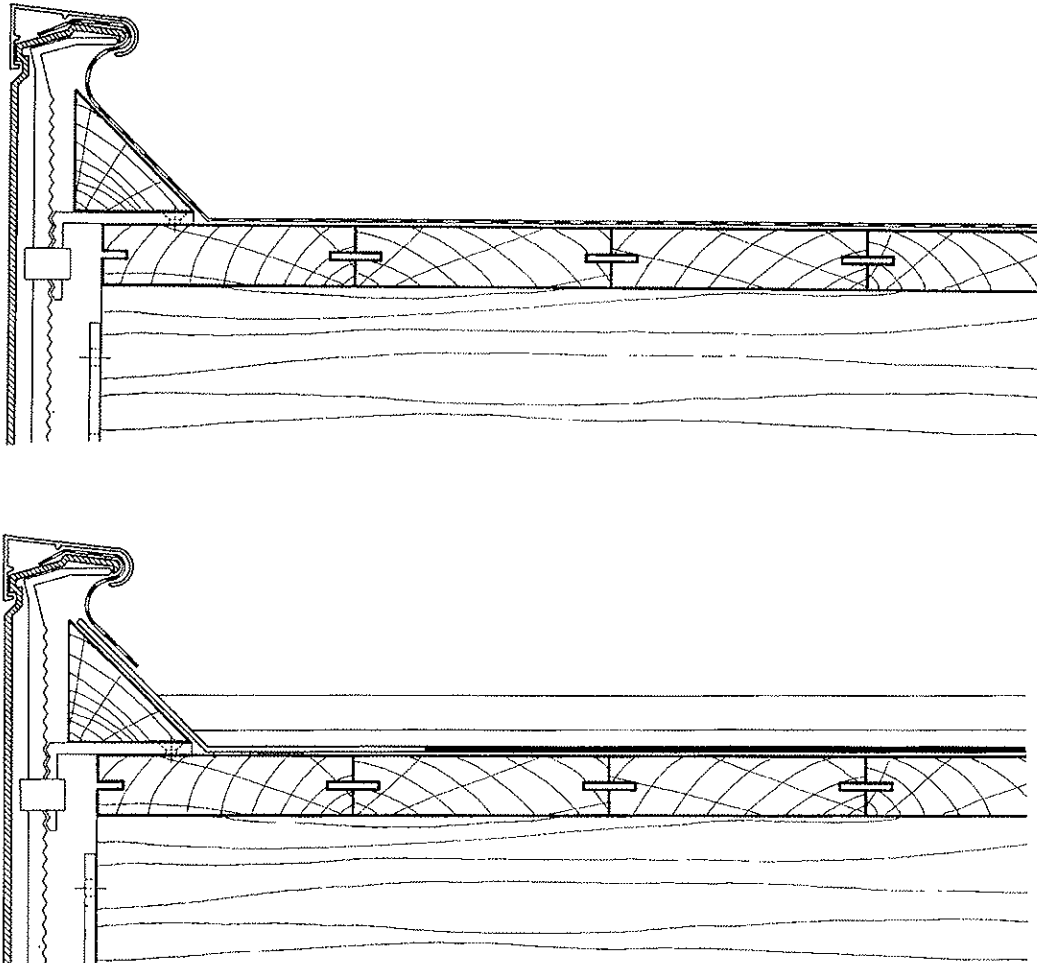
Détail-type du larmier des marquises existantes toits plats Sarnafil, en haut : usuel, en bas : avec modules étanches acier/Tefzel.
